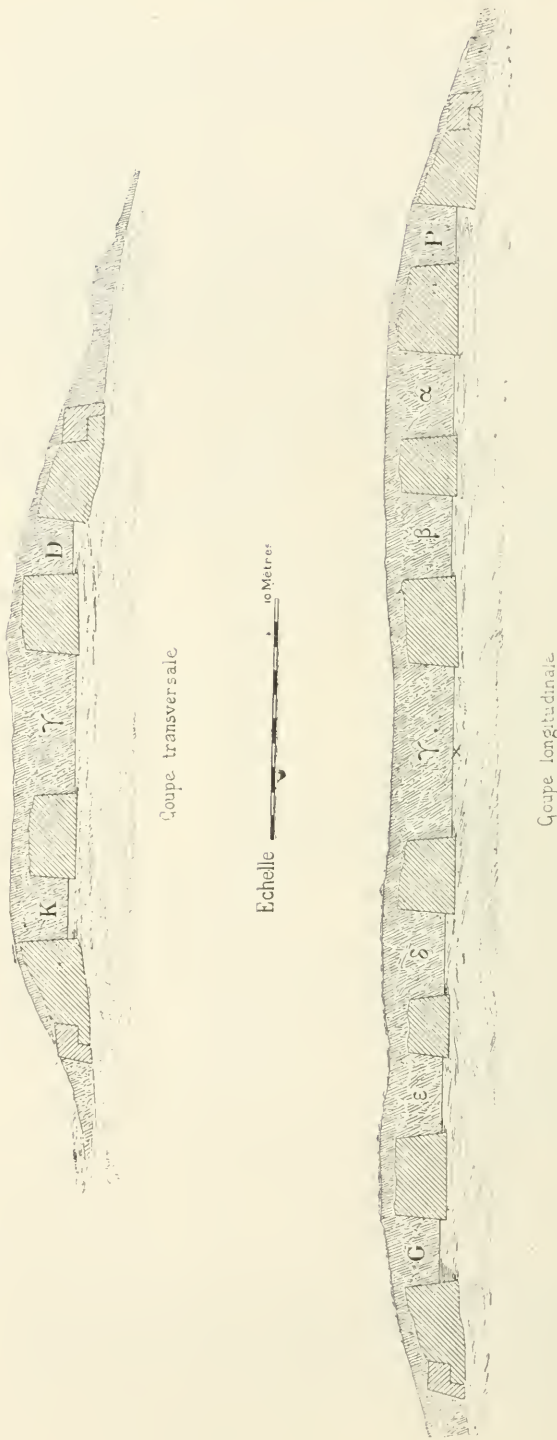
Plan du tombeau royal de Négadah (relevé et dessiné par M. G. Lampsre).
